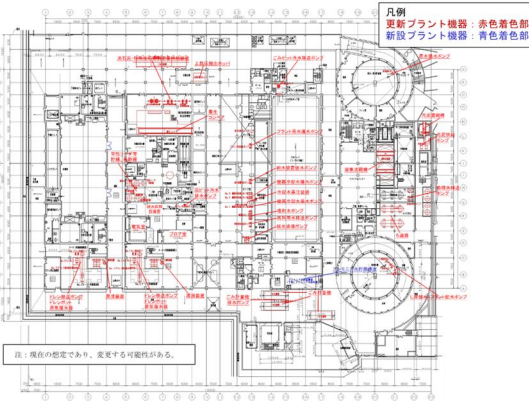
(1) 設備機器の更新箇所 (1 階平面図)
